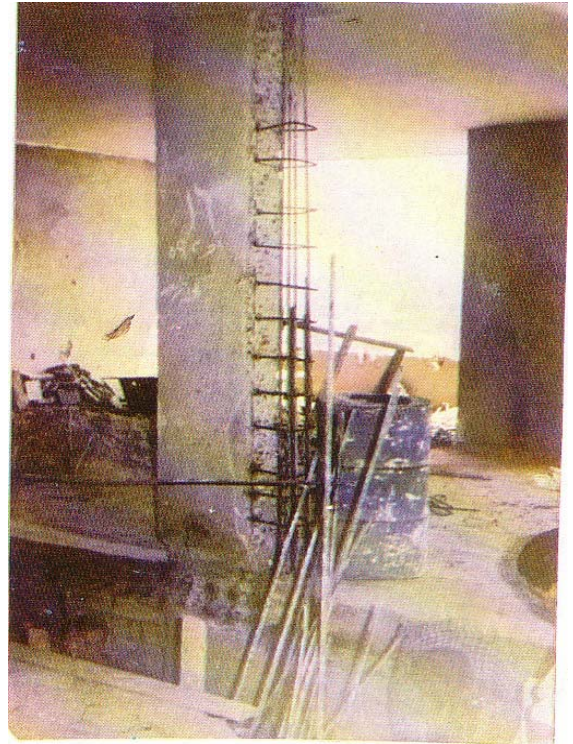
Chemisage sur une face d'un poteau en béton armé [3*]
